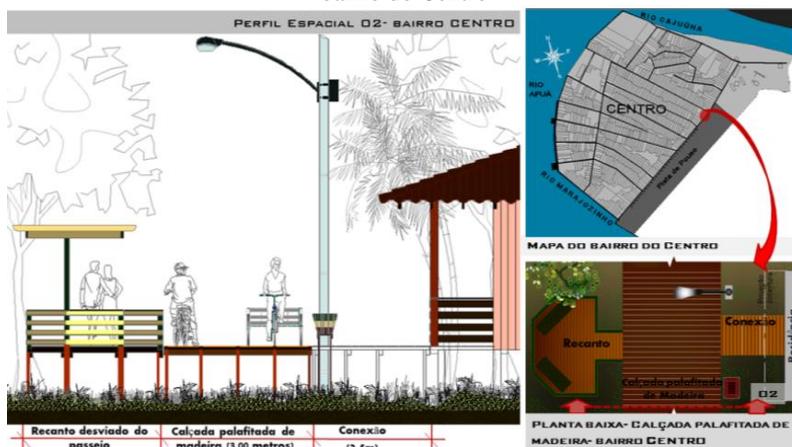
Transição calçada de madeira para concreto. Observa-se nas figuras a posição do poste de iluminação na calçada de madeira e na construída de concreto
